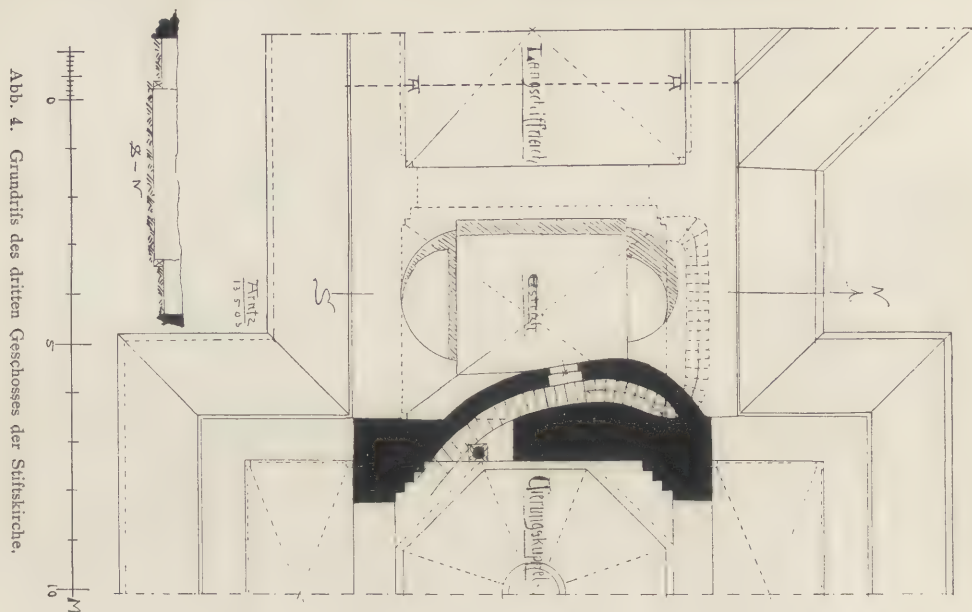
Grundriss des dritten Geschosses der Stiftskirche.
